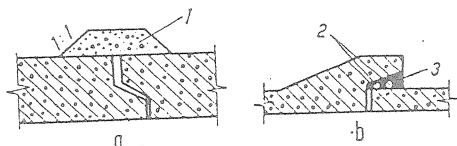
Etanșarea îmbinărilor la tuburi prefabricate din beton:
